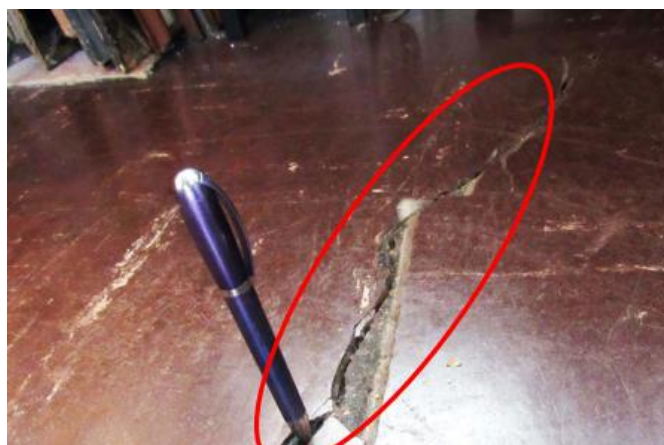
Falla 5. Fuente de la imagen: Autores.
